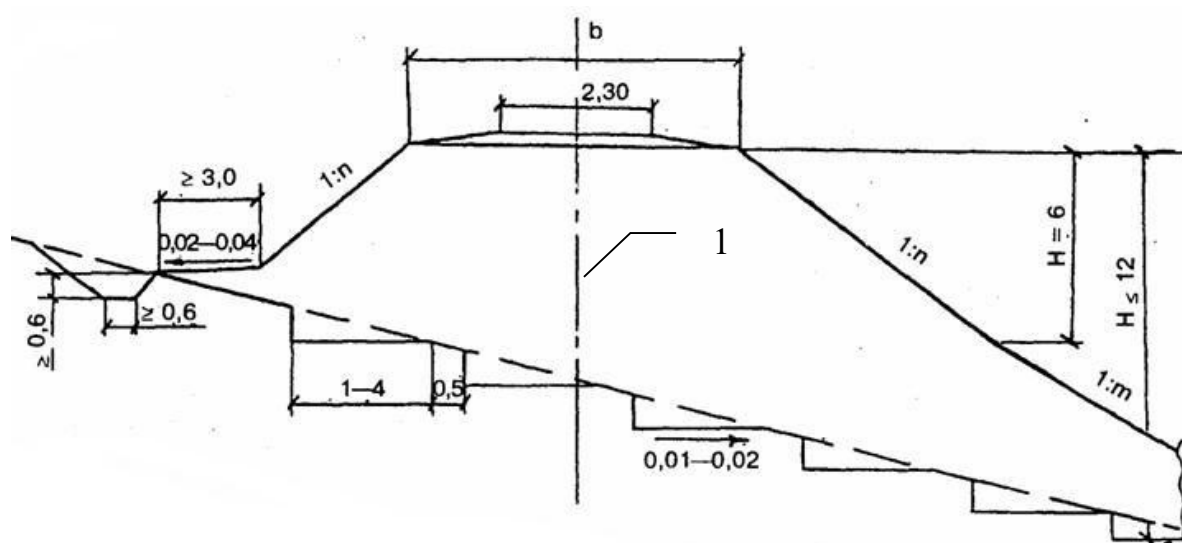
Поперечный профиль насыпи на косогоре крутизной от 1:5 до 1:3: 1 – ось пути; b – ширина основной площадки земляной насыпи [25]
